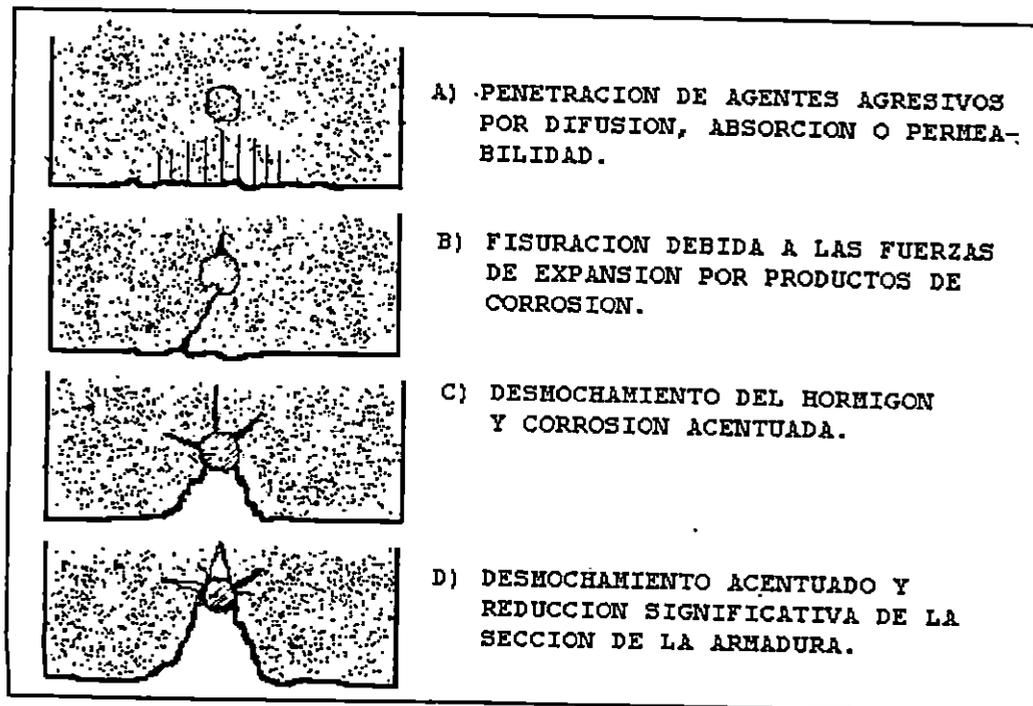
Deterioro Progresivo de las armaduras debido a la corrosión.
